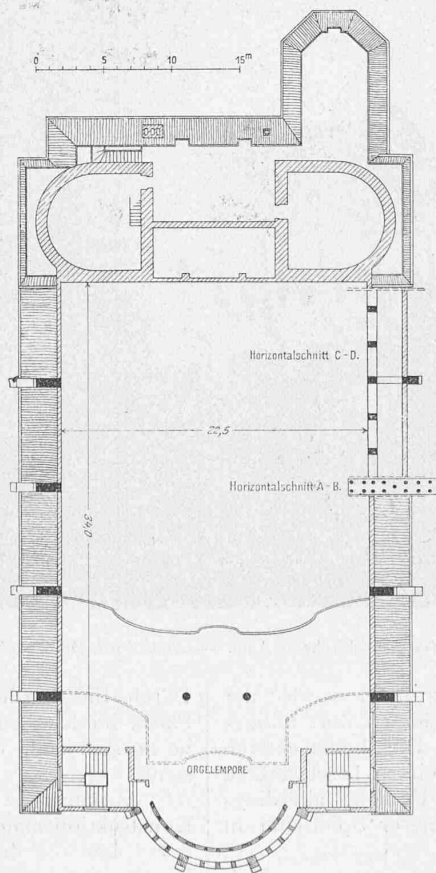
Grundriss u. Horizontalschnitte. — 1 : 500.
